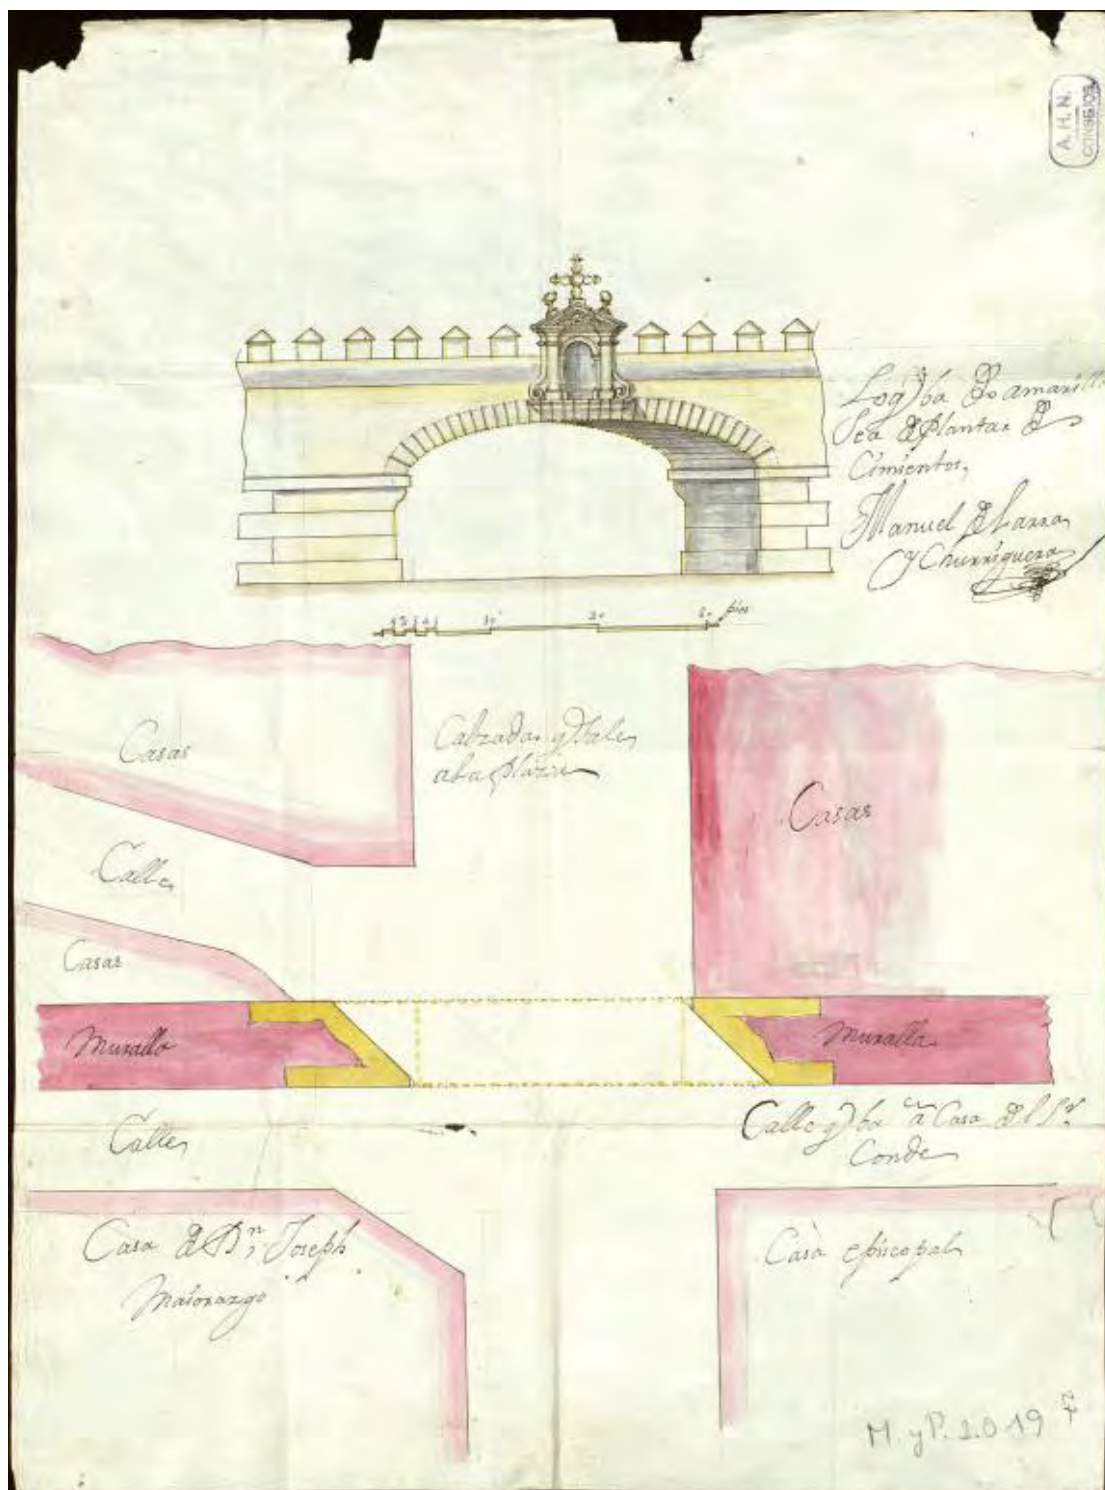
Planta y alzado del Arco de la Estrella realizado por Manuel de Larra Churriguera.
